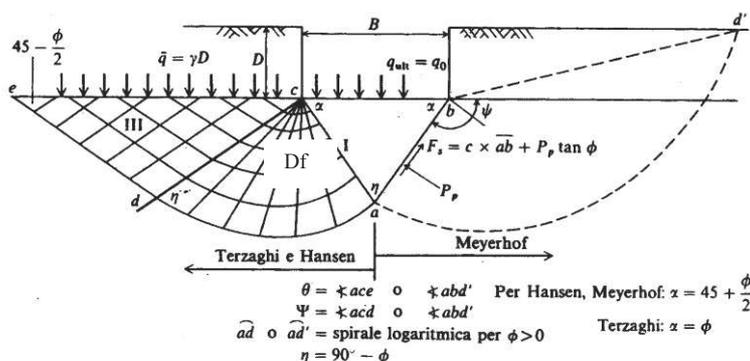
Schema del cuneo di rottura generabile inferiormente alle fondazioni.
